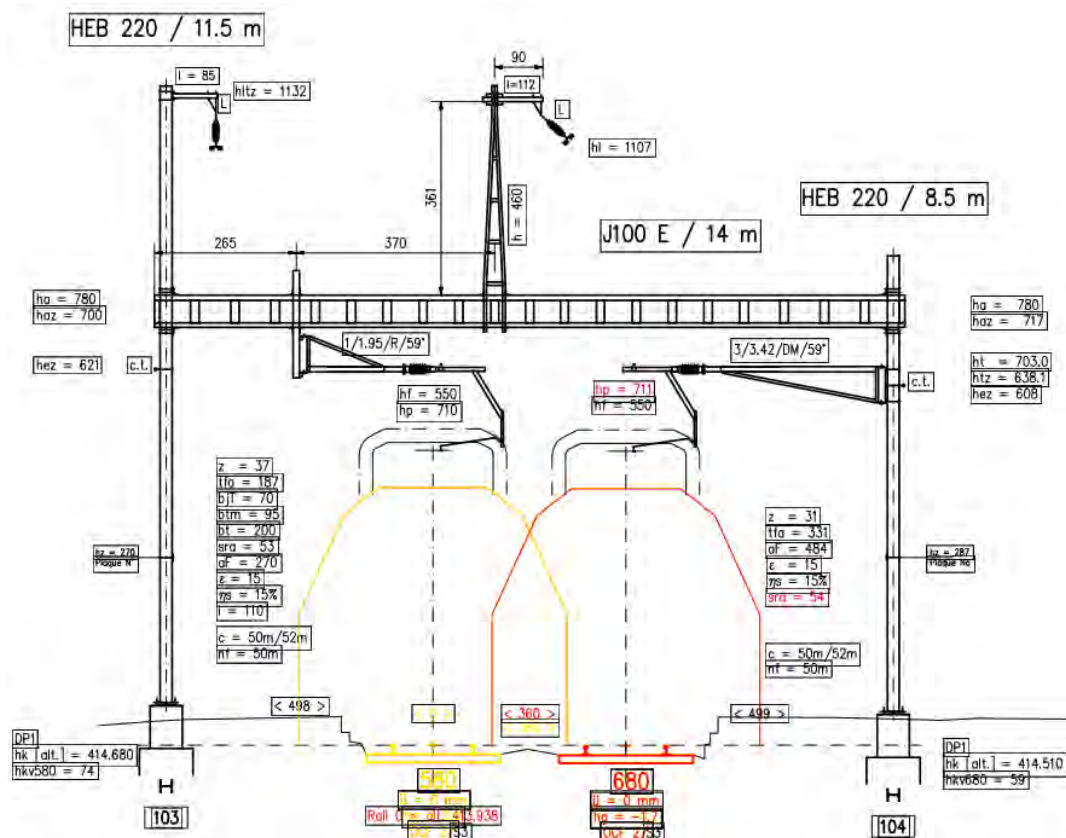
Profil en travers mâts 103-104 [12] (coupe A, vue dir. La Plaine) : PK 69.364 de la ligne CFF
